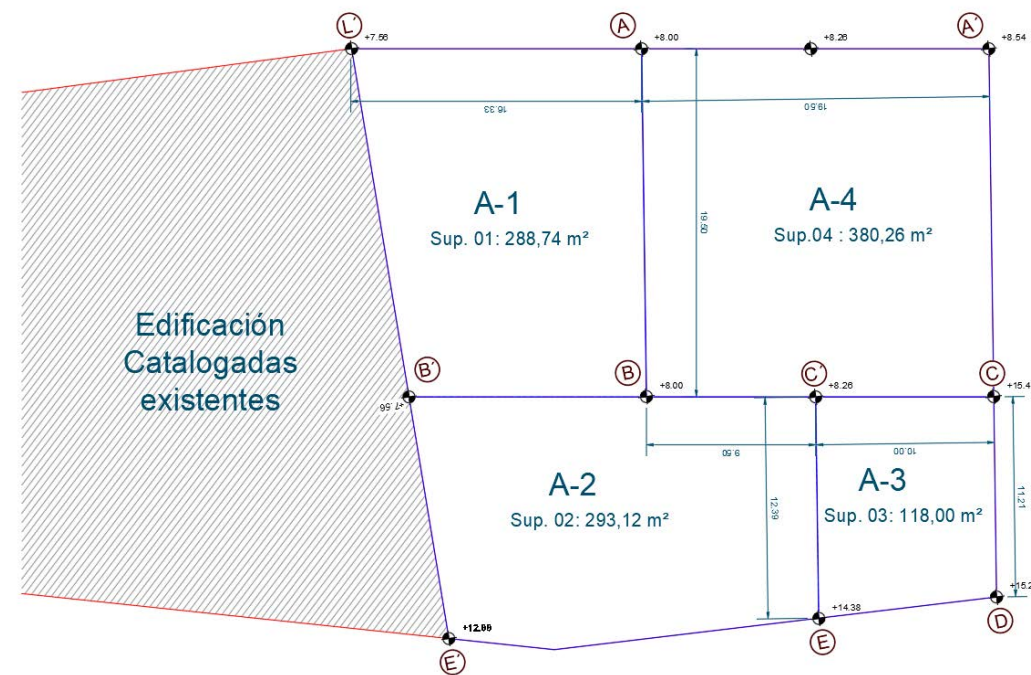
Plano de superficies, redibujado según plano de Ordenación Detallada
